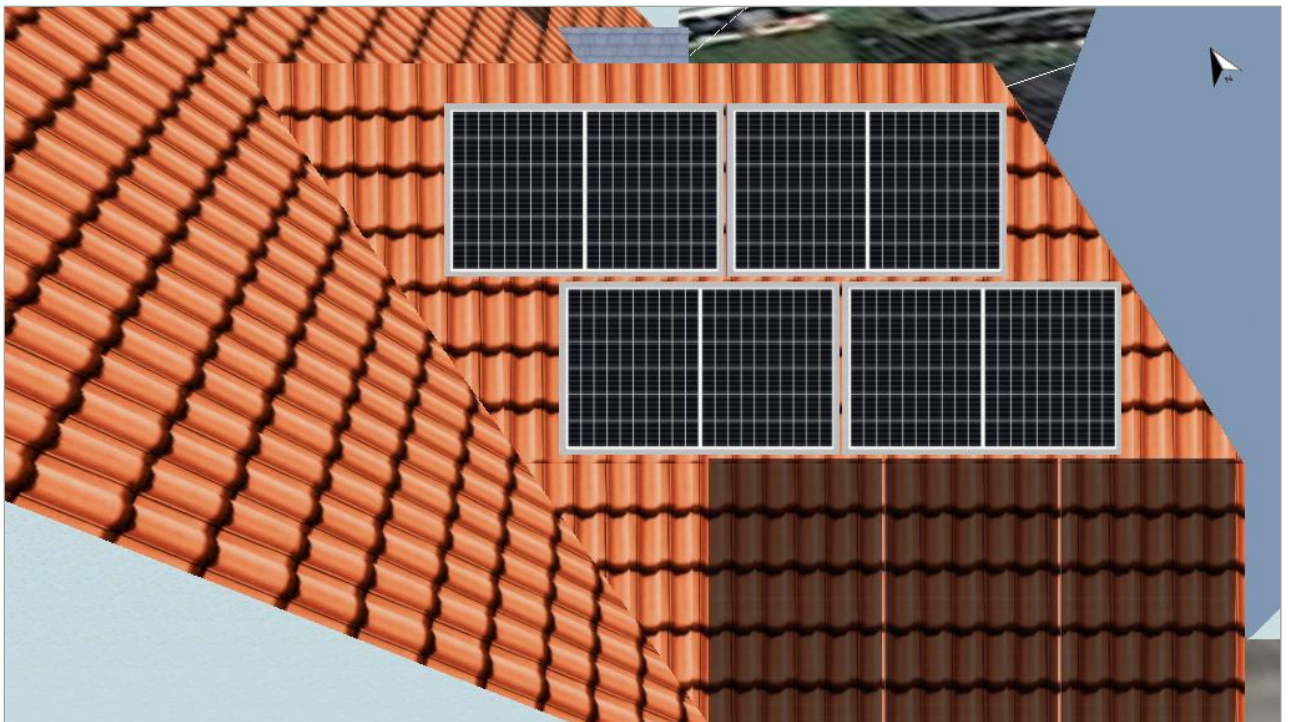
Modulfläche - Gebäude 02-Dachgeschoss2-Dachfläche Südwest
